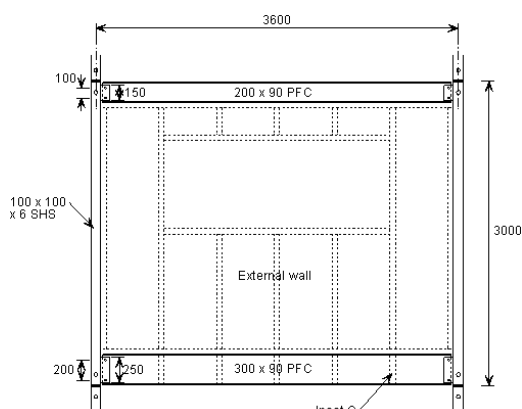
VIGAS DE BORDE LONGITUDINAL DE UN MODULO DE ESQUINA APOYADA.
